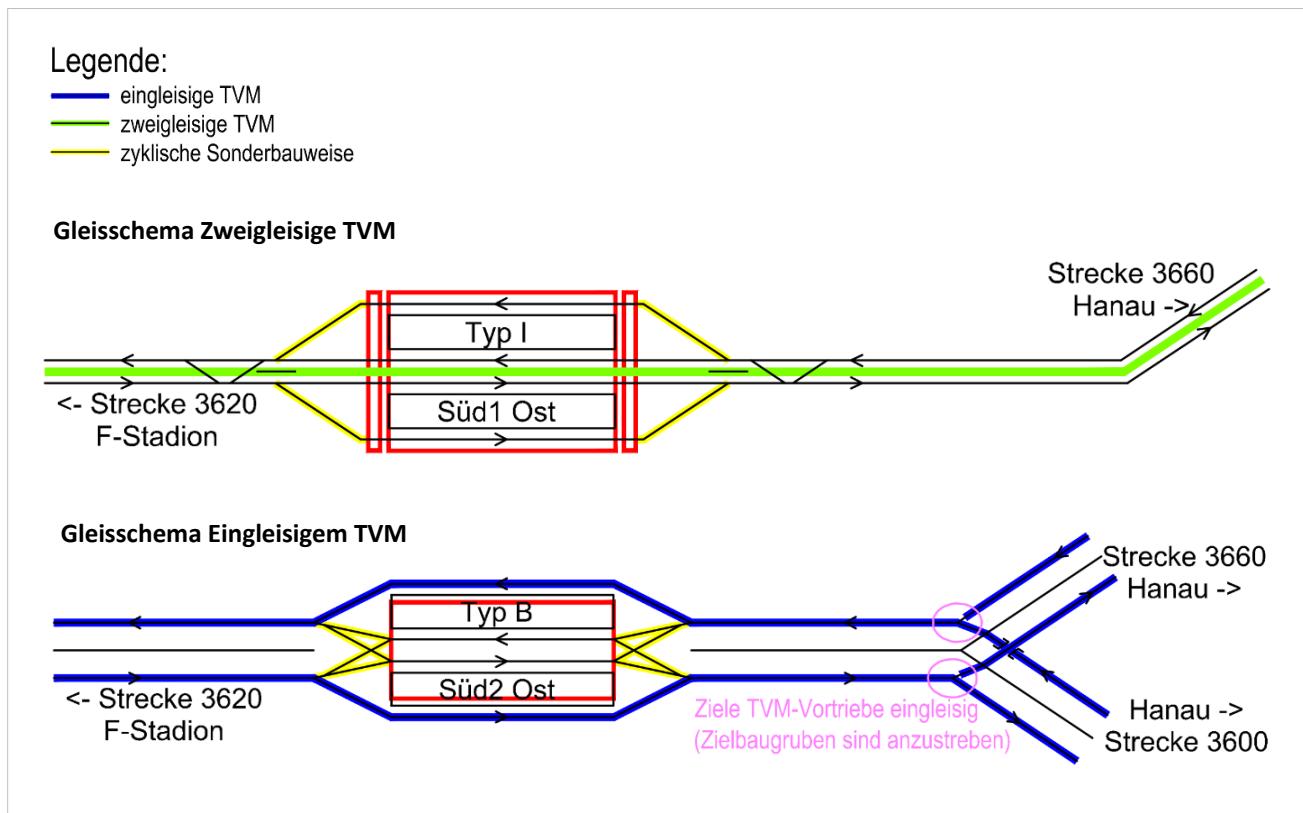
Beispiel einer Tunnelbaumaßnahme anhand verschiedener Vortriebsvarianten
